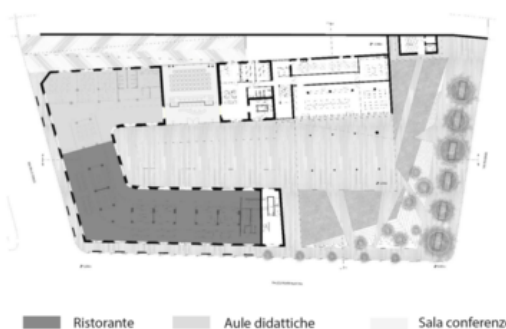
Planimetria dello stato di progetto relativo all'edificio esistente (piano terra)
